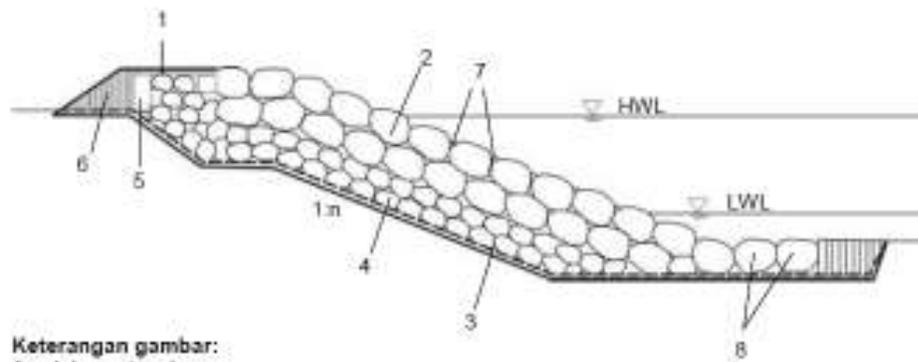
Bangunan Pengaman Pantai - Revetmen
